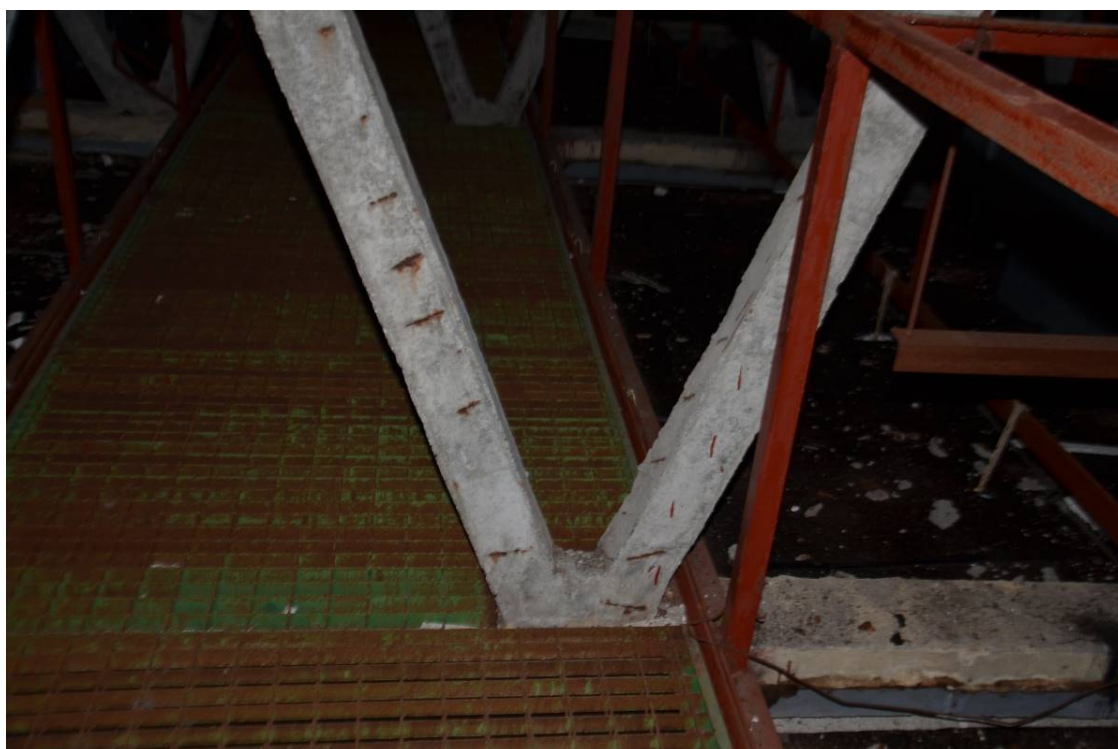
Staticky významná koroze výztuže příhradových vazníků
